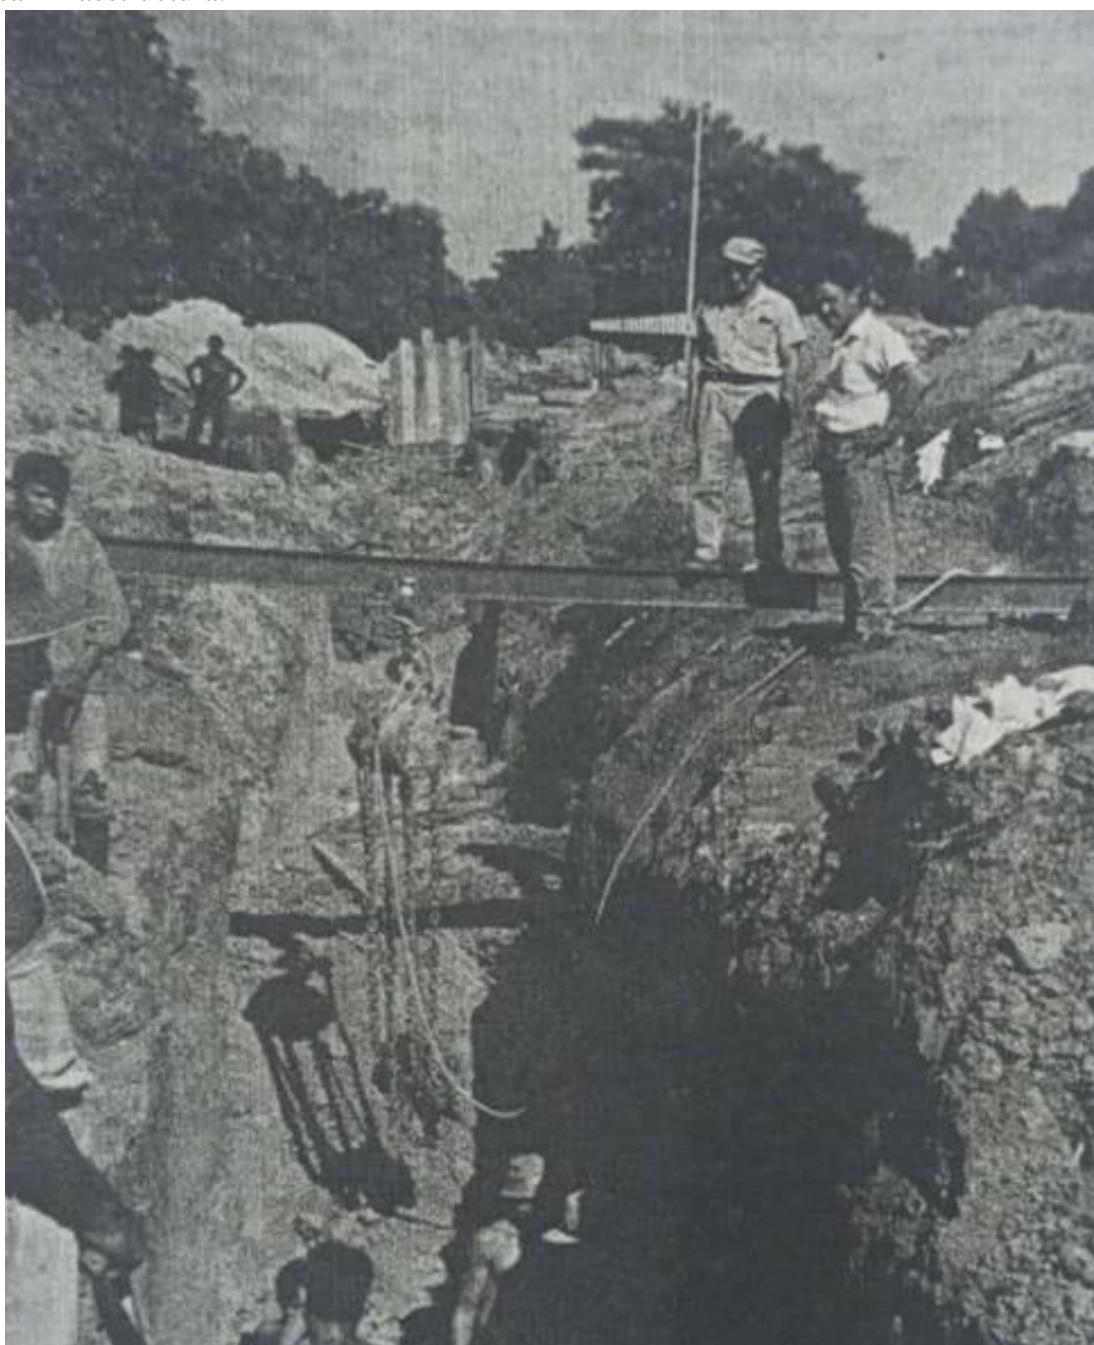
Entubamiento de la Zanja de Desagüe a la altura de las intersecciones de las actuales avenidas Artigas, Pedro Ferré y Santa Rosa 1966. Fuente Minadeo, 2008
